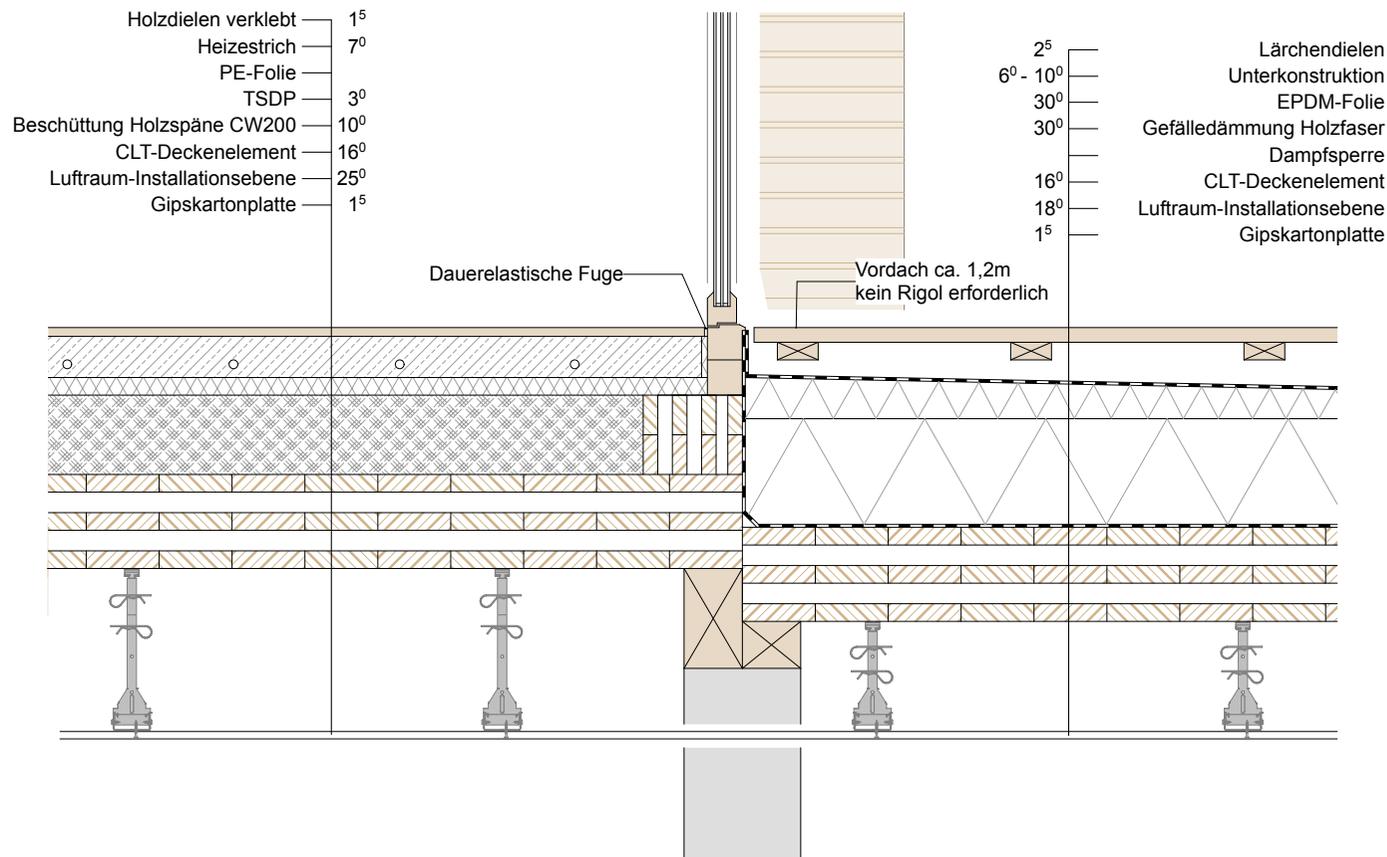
Terrassenanschluss Bewohnergruppe 1.OG M 1:20
